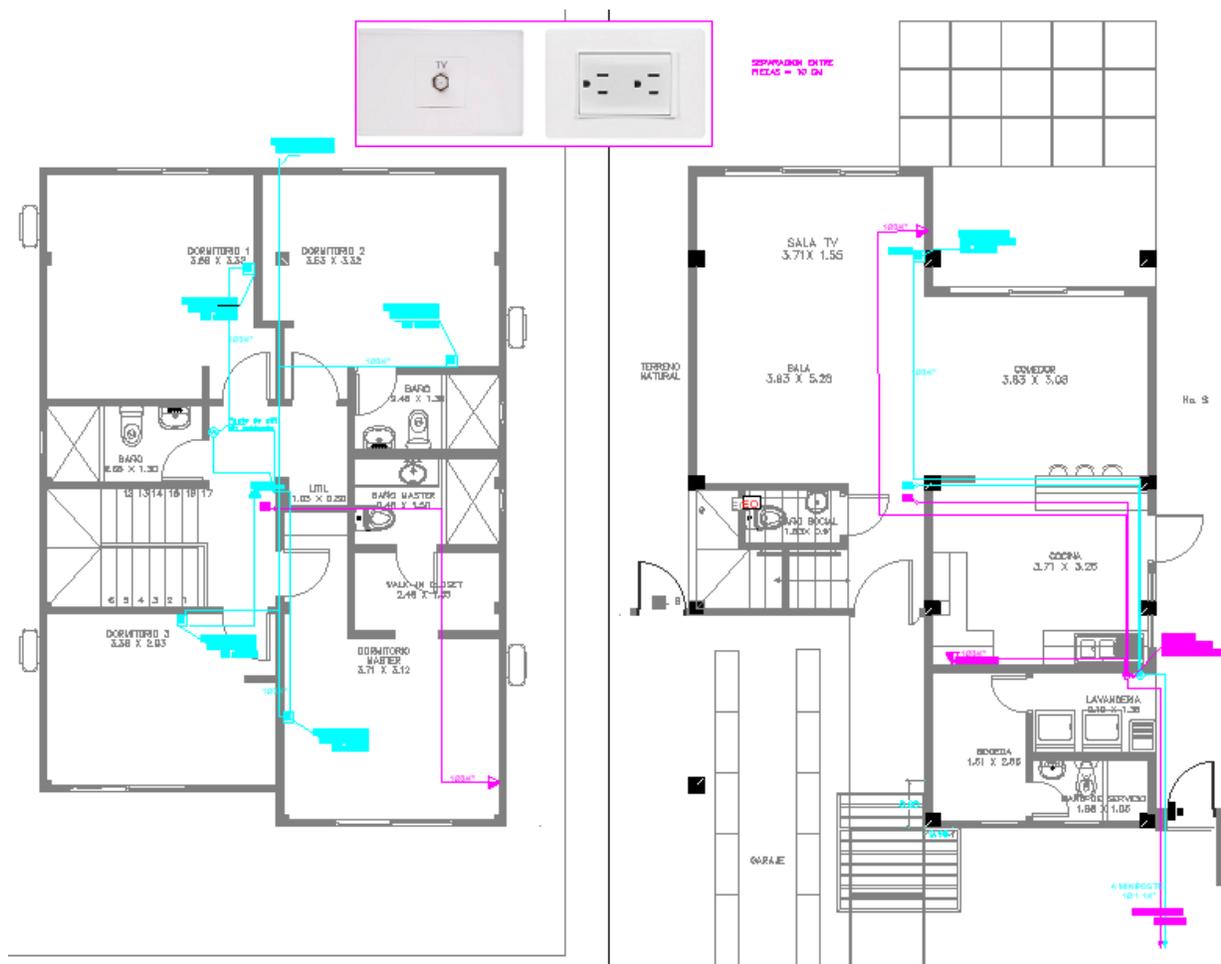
Plano de instalaciones eléctricas de planta baja en Revit. (Autor)
